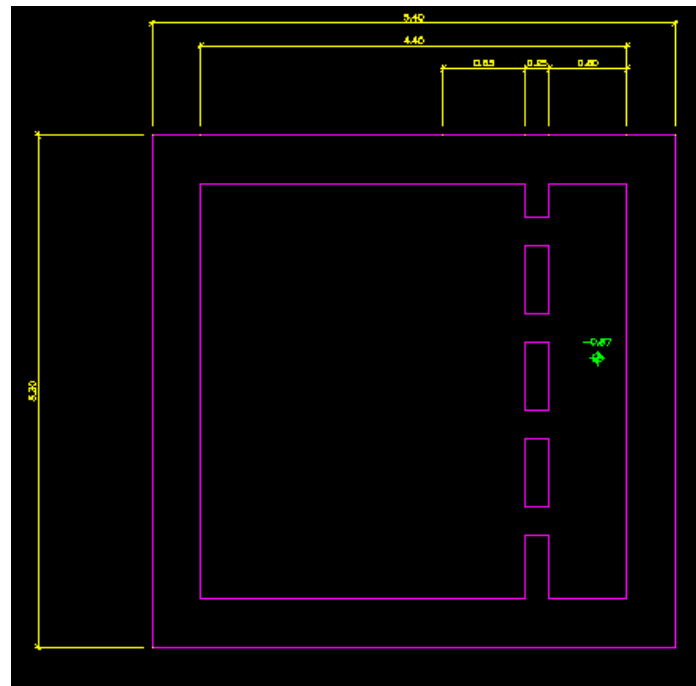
Planta nivell -1,07m, pou bombes de l'EBAR de Llafranc dissenyat.
